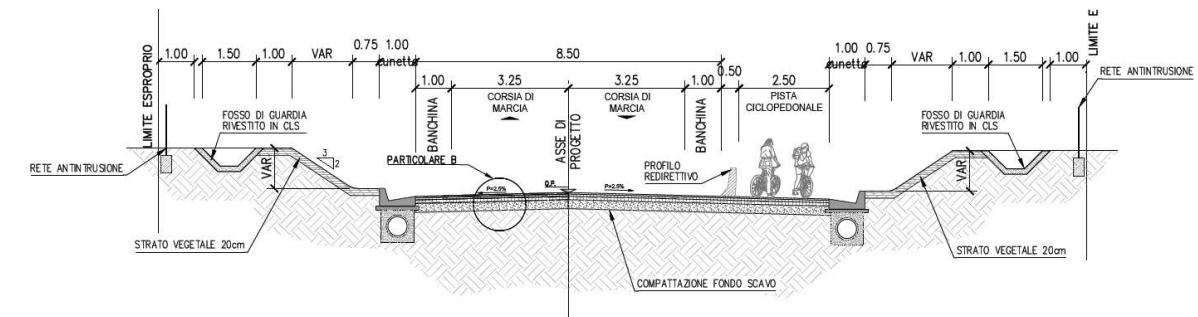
Sezione tipo deviazione Collestrada in scavo
